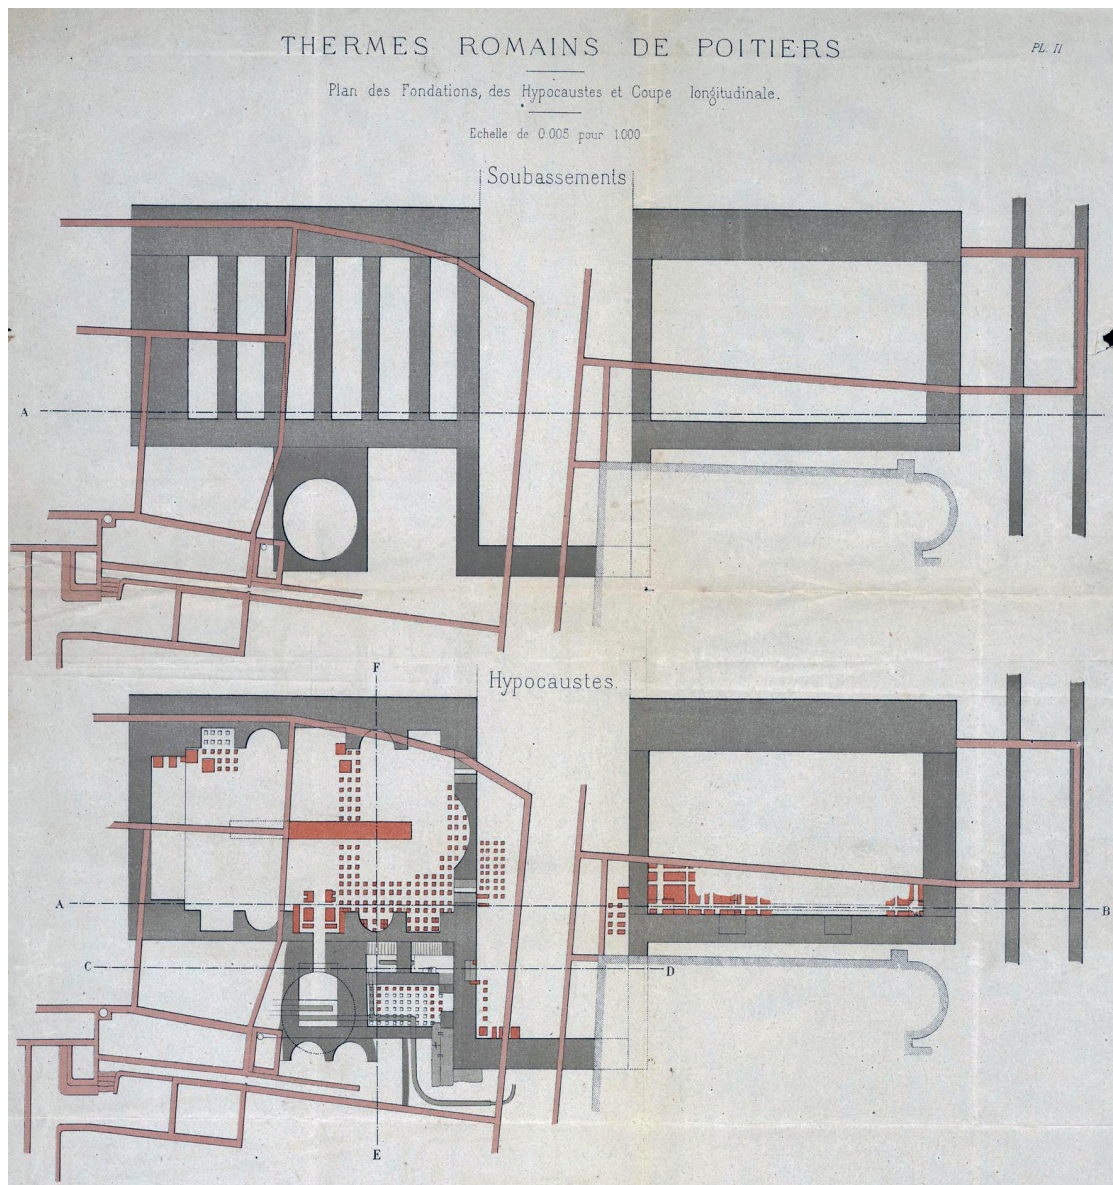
Plan publié par le père de la Croix, daté d'avril 1878 (FRAD86\_16J3\_119\_006). En rose, les murs de clôture des différentes propriétés modernes.
